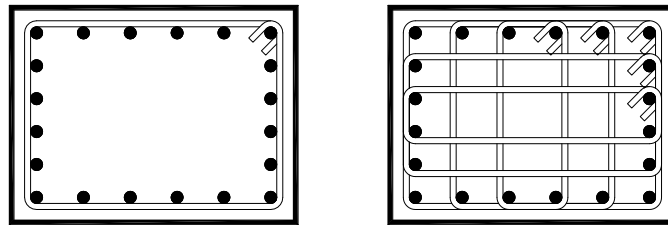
Secciones rectangulares (Priestley et al., 1996).
